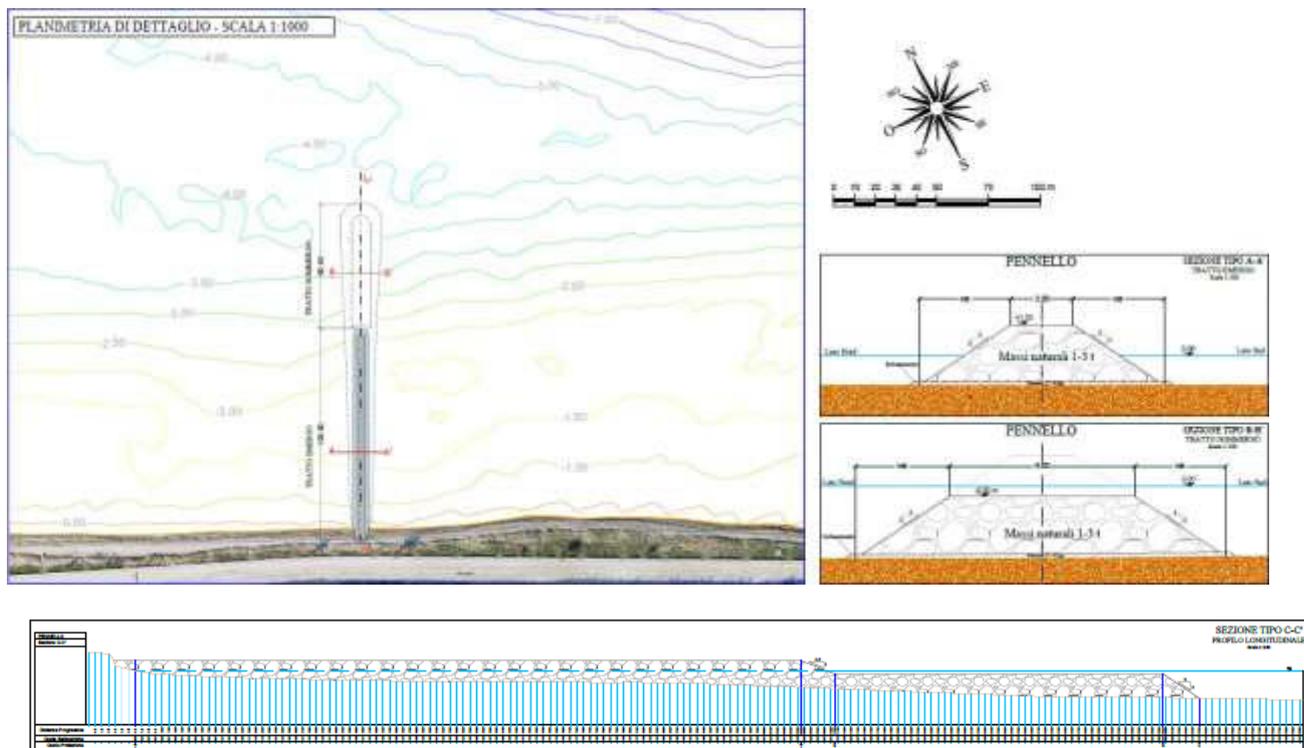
Planimetria e sezioni tipo della configurazione di progetto.
